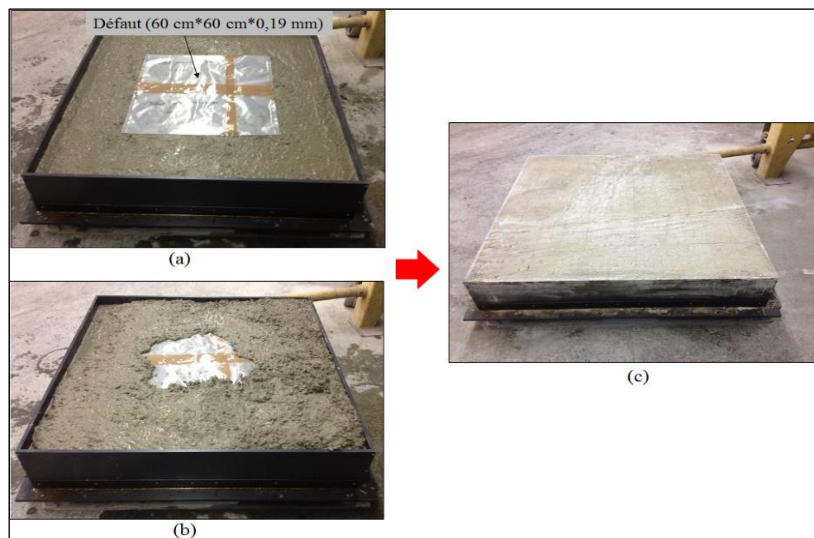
Dalle N° 6, (a) Mise en place du défaut, (b) Remplissage du moule, (c) Dalle monolithique fabriquée.
